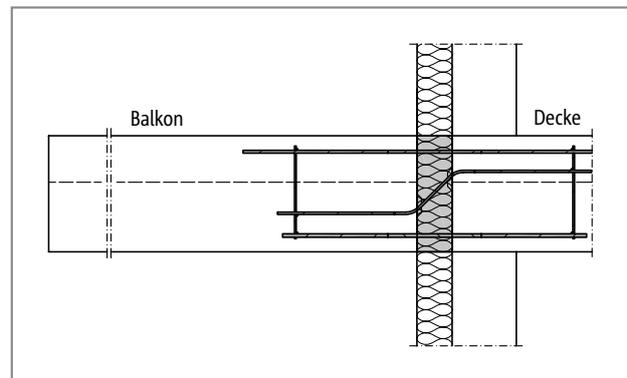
Schöck Isokorb® Typ SXT: Balkonkonstruktion mit frei auskragenden Unterzügen
